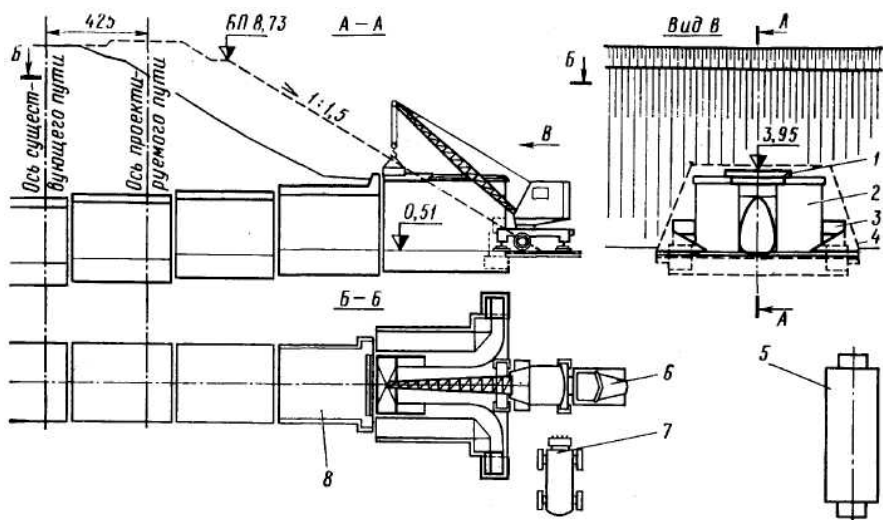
Удлинение овоидальной трубы с оголовком коридорного типа (размеры в сантиметрах): 1 – железобетонные плиты перекрытия; 2 – входной оголовок; 3 – блоки удлинения крыльев оголовка; 4 – граница укрепления насыпи бетонными плитами; 5 – склад сборных элементов; 6 – стойка автомобильного крана для установки элементов перекрытия и крыльев оголовка; 7 – стойка компрессора; 8 – секция существующей трубы
